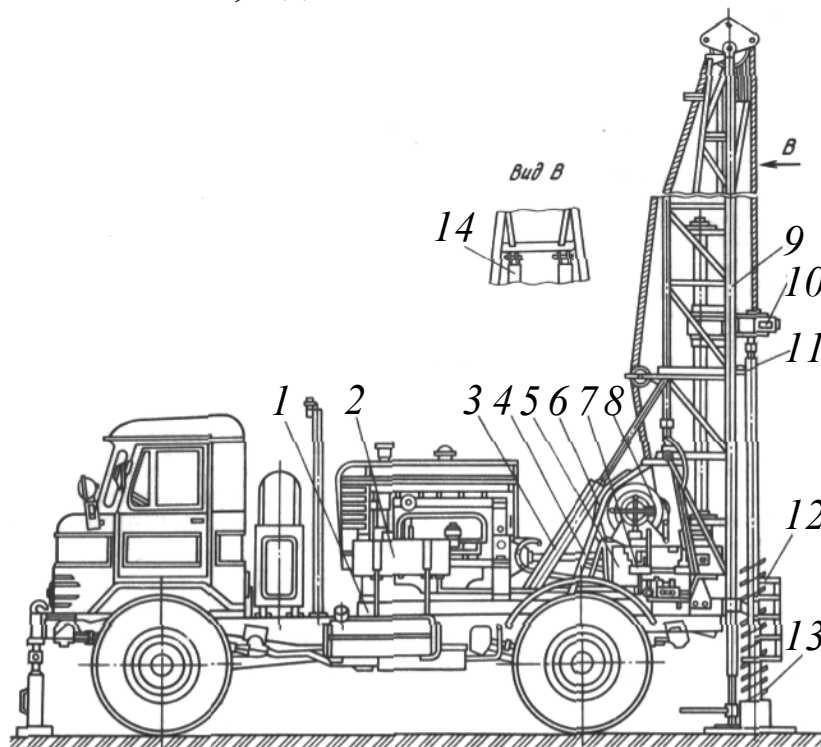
Установка для гидрогеологического бурения УГБ-50М: 1 – рама; 2 – двигатель; 3 – гидродомкраты опускания и подъема мачты; 4 – ударный механизм; 5 – коробка передач; 6 – тормоза; 7 – пульт управления; 8 – лебедка; 9 – мачта; 10 – вращатель; 11 – осветительные фары; 12 – ограждение; 13 – шнек; 14 – гидродомкраты подачи
